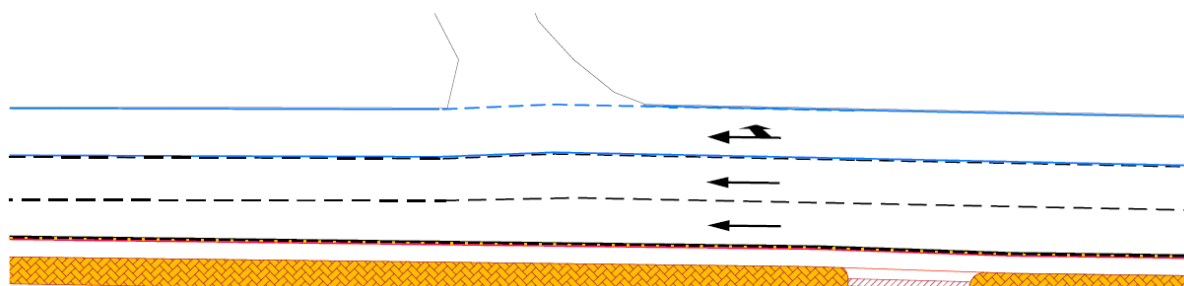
Entradas e Saídas de ruas à direita da Avenida Lúcio Meira (Reta)
